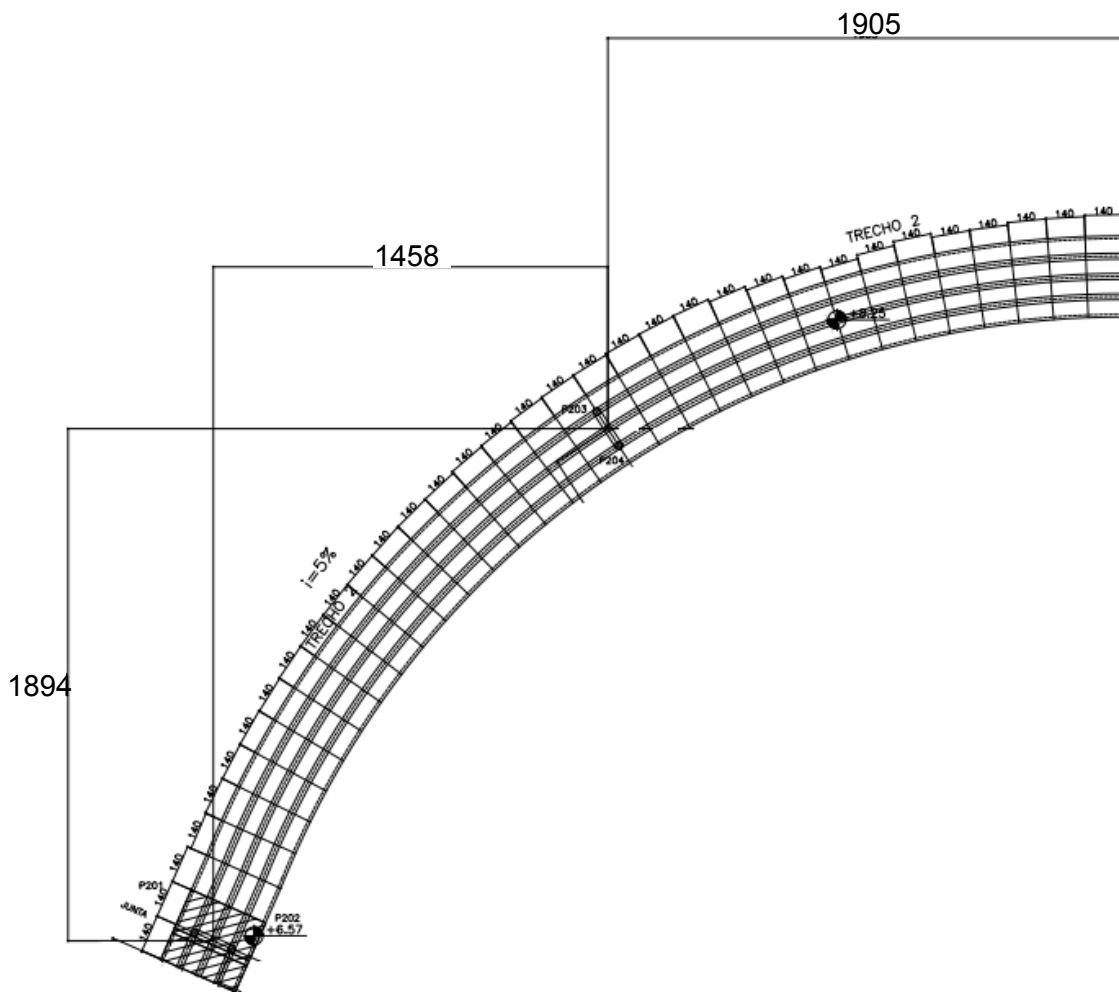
Passarela Terminal Centro Olímpico: Vista superior Trecho 2 (dimensões em cm)
